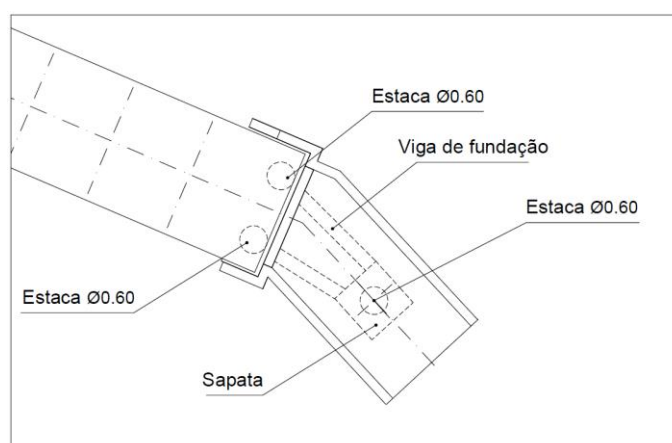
Vista em planta da fundação indirecta do encontro E2 [2]
